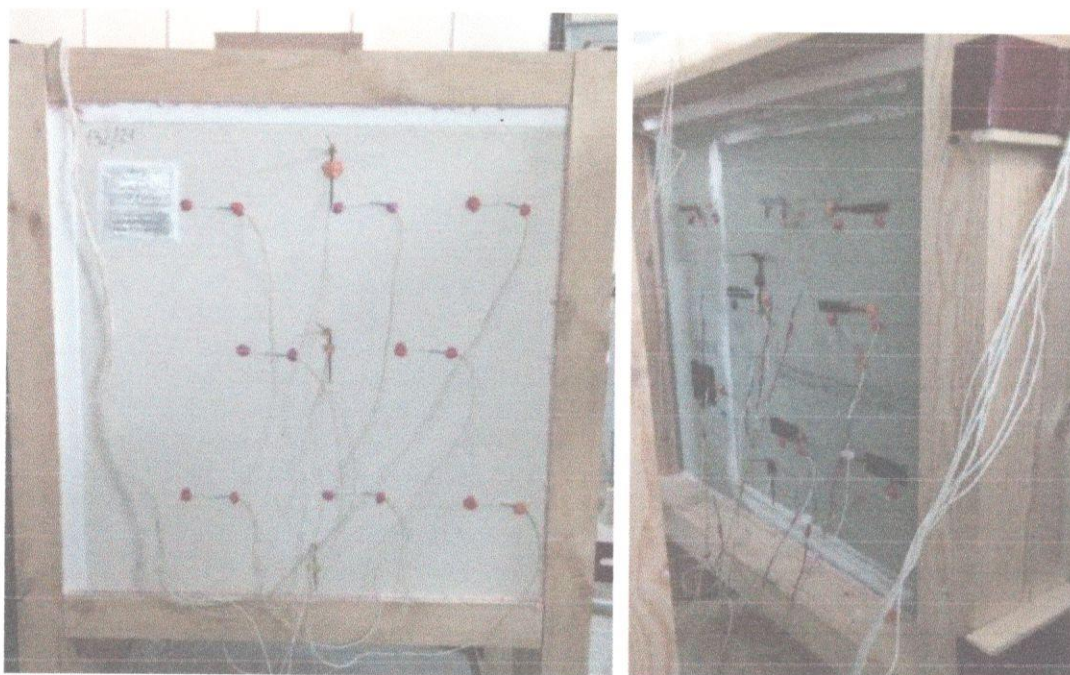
Загальний вигляд зразка № 132/21 під час випробування
